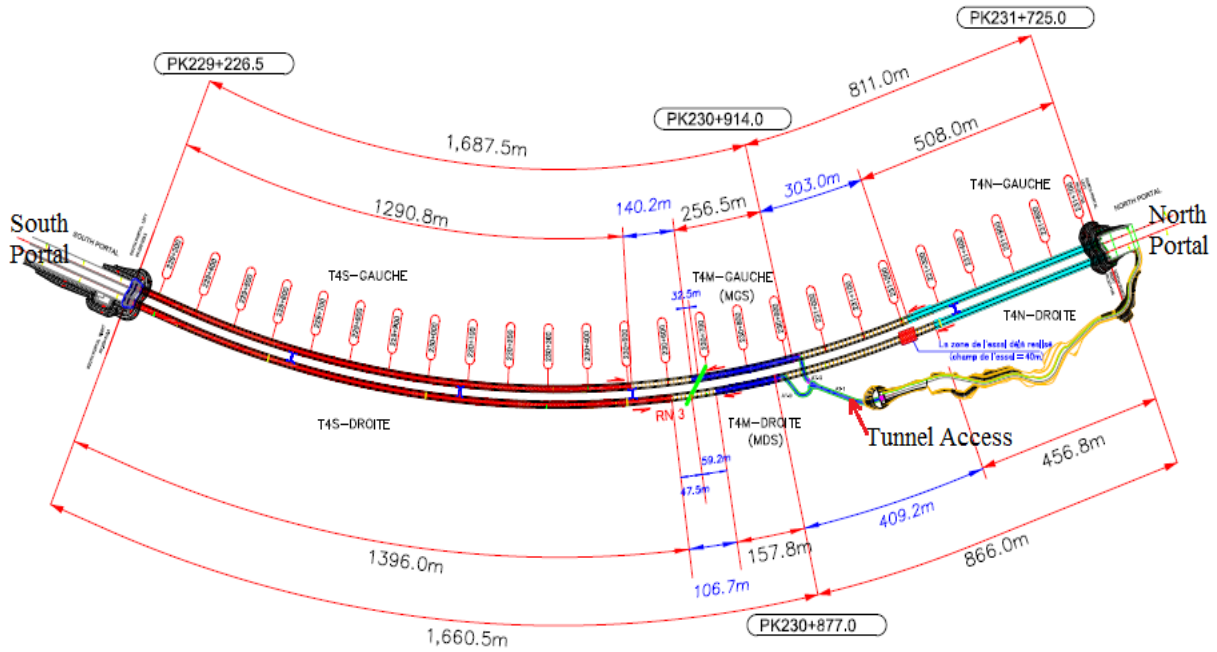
Vue en plan et section longitudinale du tunnel T4.
